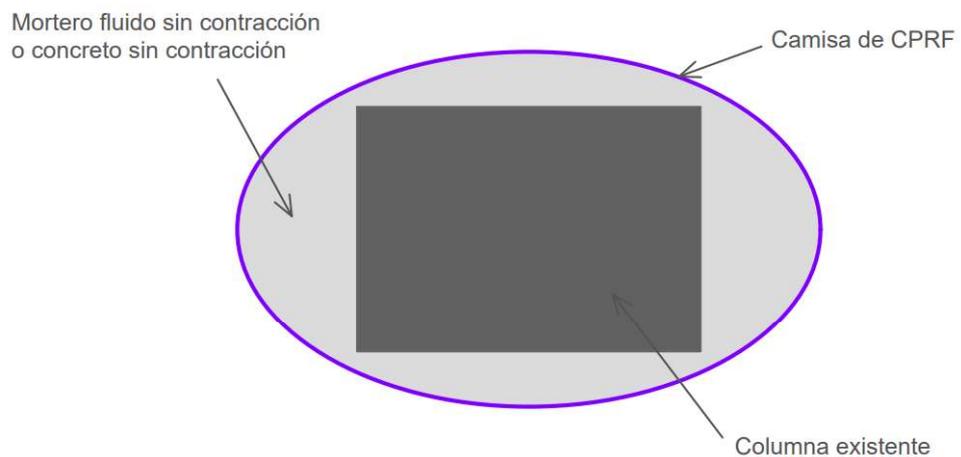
Ejemplo de modificación de una columna con sección transversal rectangular a una con sección ovalada mediante un encamisado de CPRF
